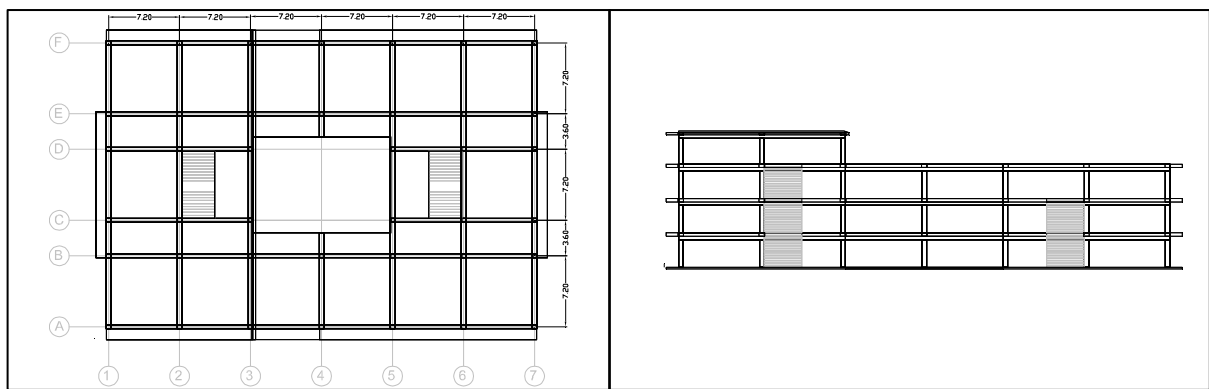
Plano de planta (izquierda) y plano de pórtico tipo en dirección longitudinal (derecha)
